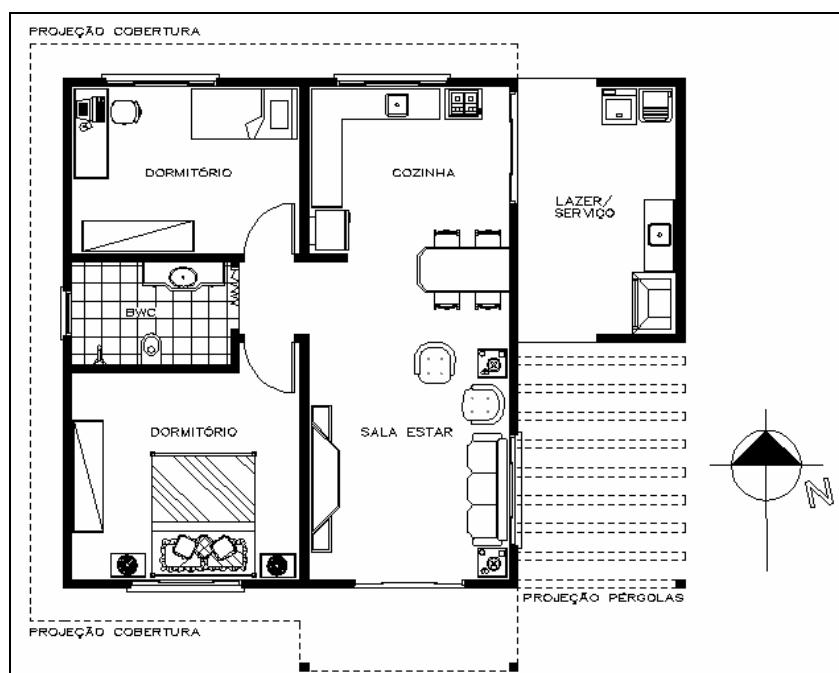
Planta Baixa, sugestão de projeto (sem escala)
